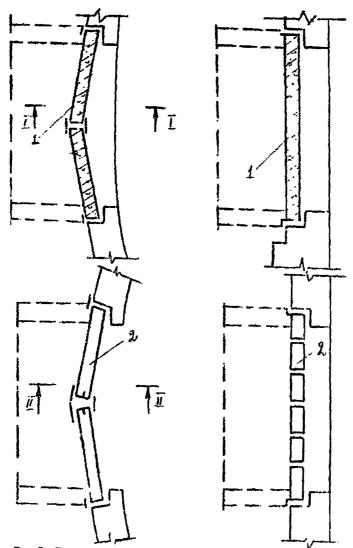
Примеры решений закладывания проемов в стенах: 1 — железобетооные панели; 2 — стальные щиты
